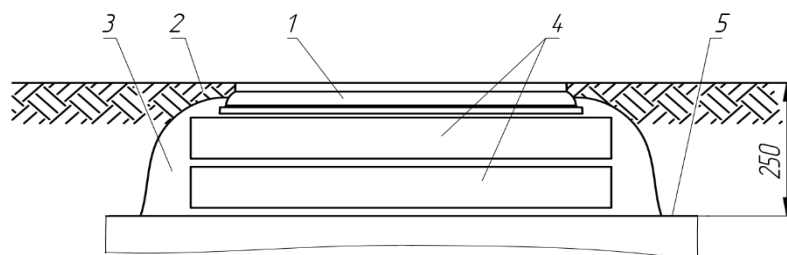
Расстояние от перекрытия колодца до уровня земли (асфальта) на тротуаре и газоне должно быть – не менее 250 мм: 1 – люк чугунный; 2 – уровень земли на газоне, асфальта на тротуаре; 3 – обмазка горловины бетоном со щебнем; 4 – опорные кольца типа КО; 5 – перекрытие колодца «ККСр-4-10».
